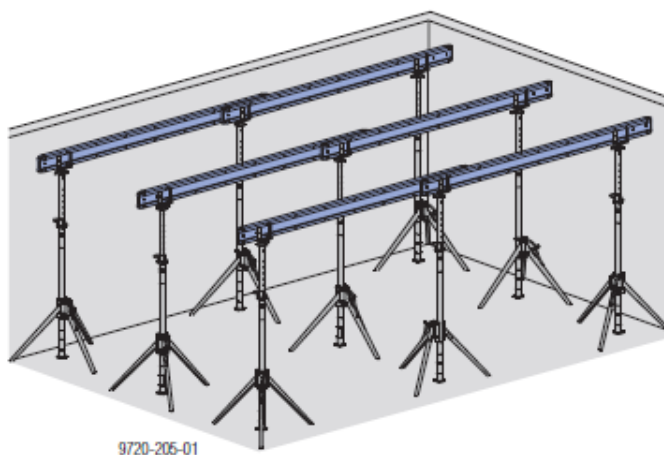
Nastavení stropních podpěr pomocí třmenů [57]
